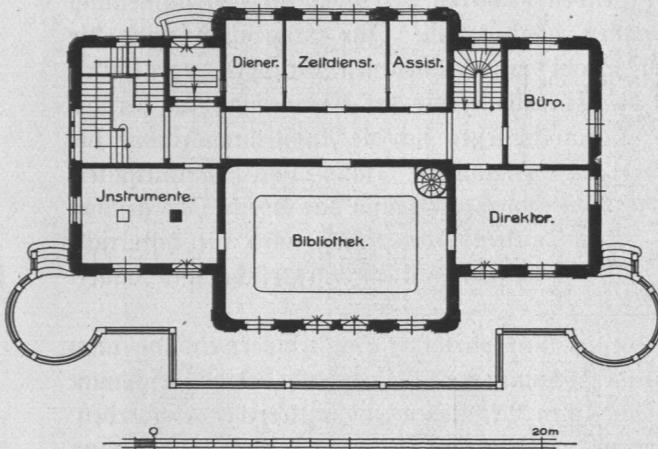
Sternwarte, Hauptdienstgebäude, Erdgeschoss, Grundriß.
